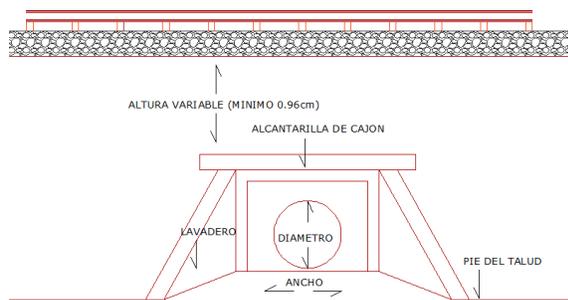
Detalle de relleno con alcantarillado. (Fuente: Autor)
